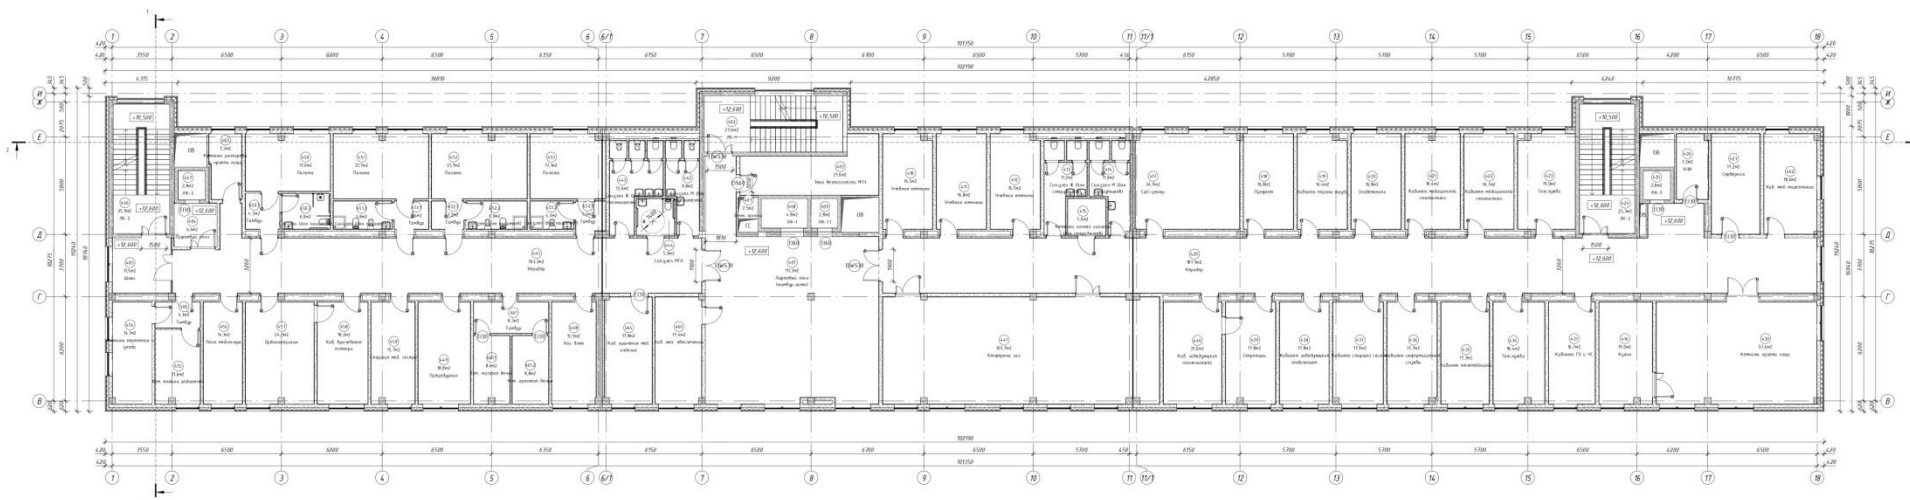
План четвертого этажа на отметке + 12,600
